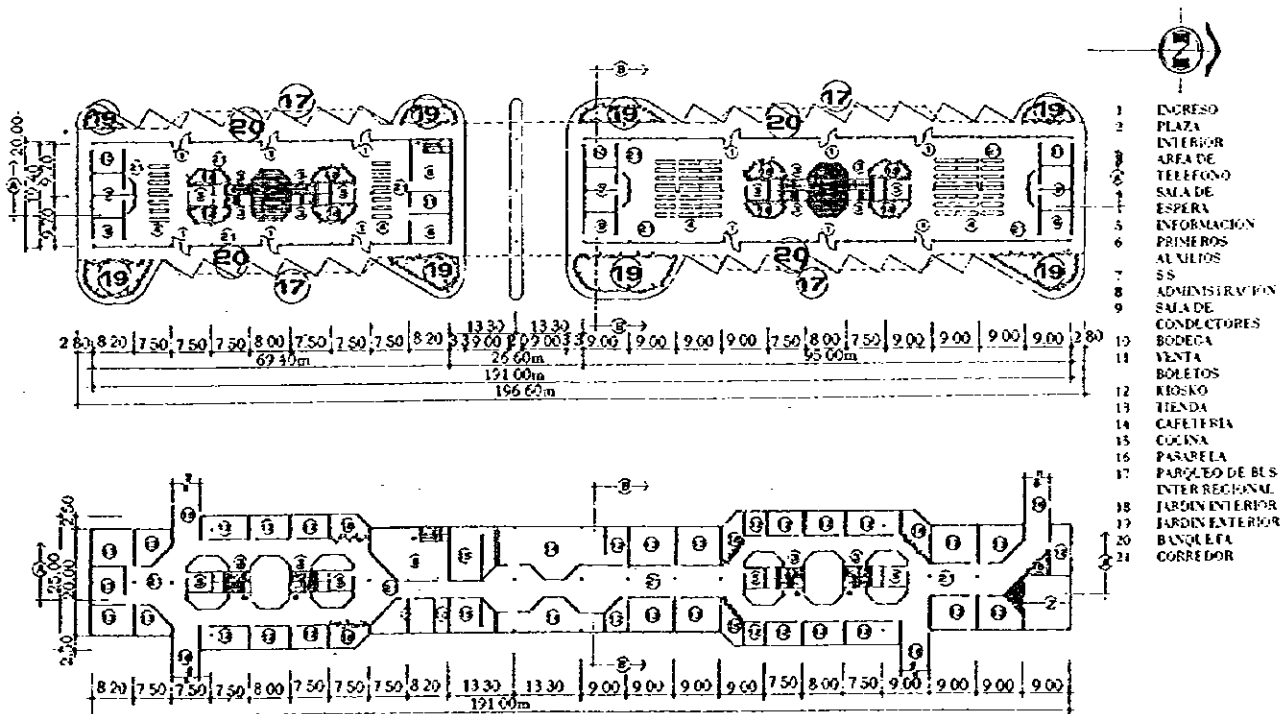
Planta del Primer y Segundo Nivel Terminal Inter-regional de Bus Sur
